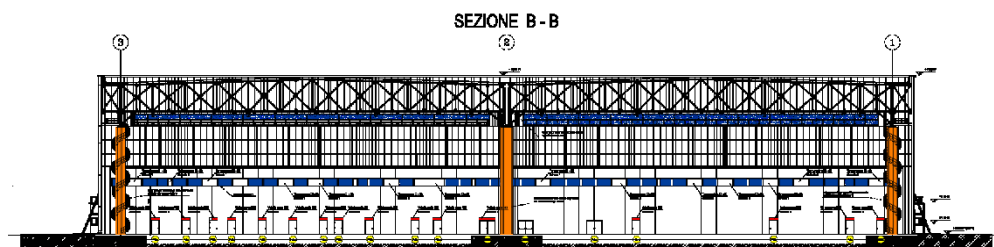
Hangar aviorimessa: sezione in corrispondenza dei pilastri
